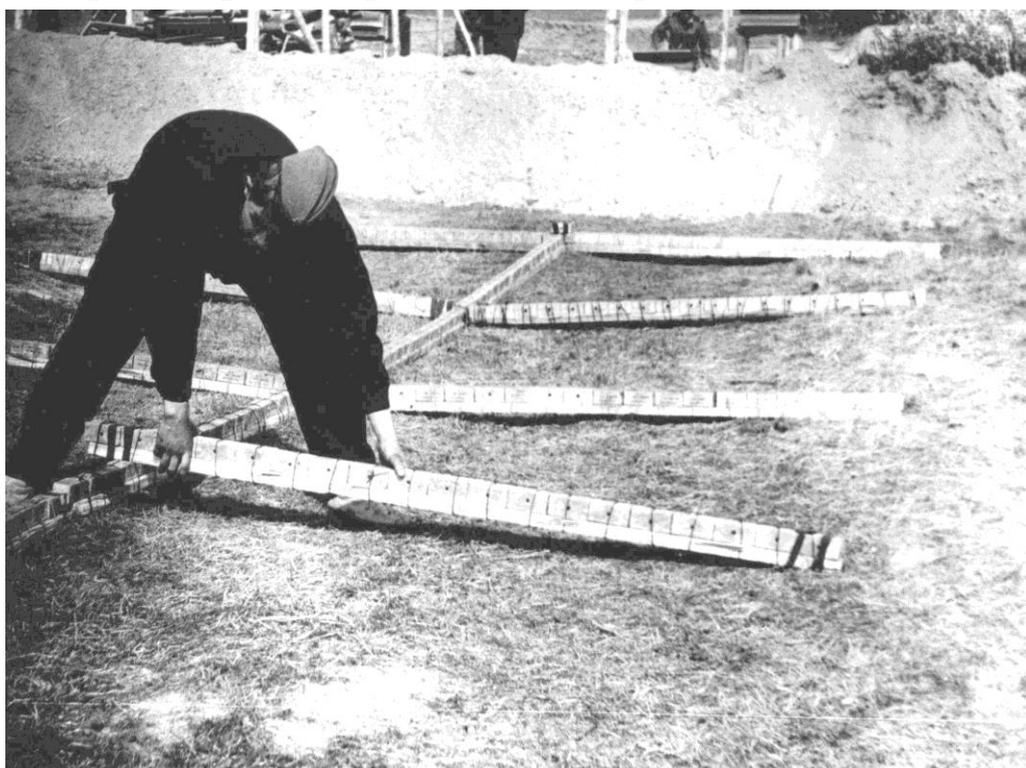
Изготовление и подготовка заряда для вскрытия бетонной подушки для шахтеров. Рядовой Д.В. Мельничук
